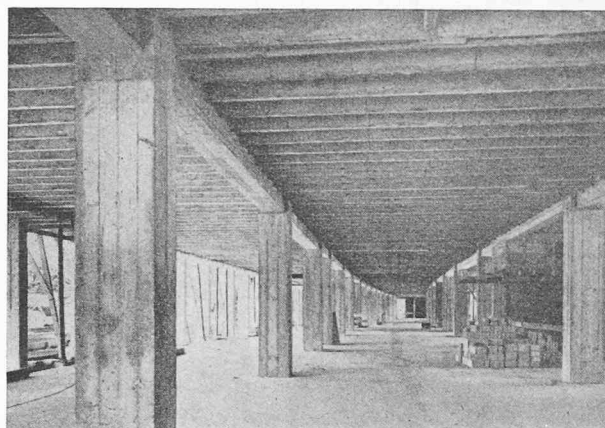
Ossature en béton armé. Planchers nervurés sur sommiers longitudinaux.
